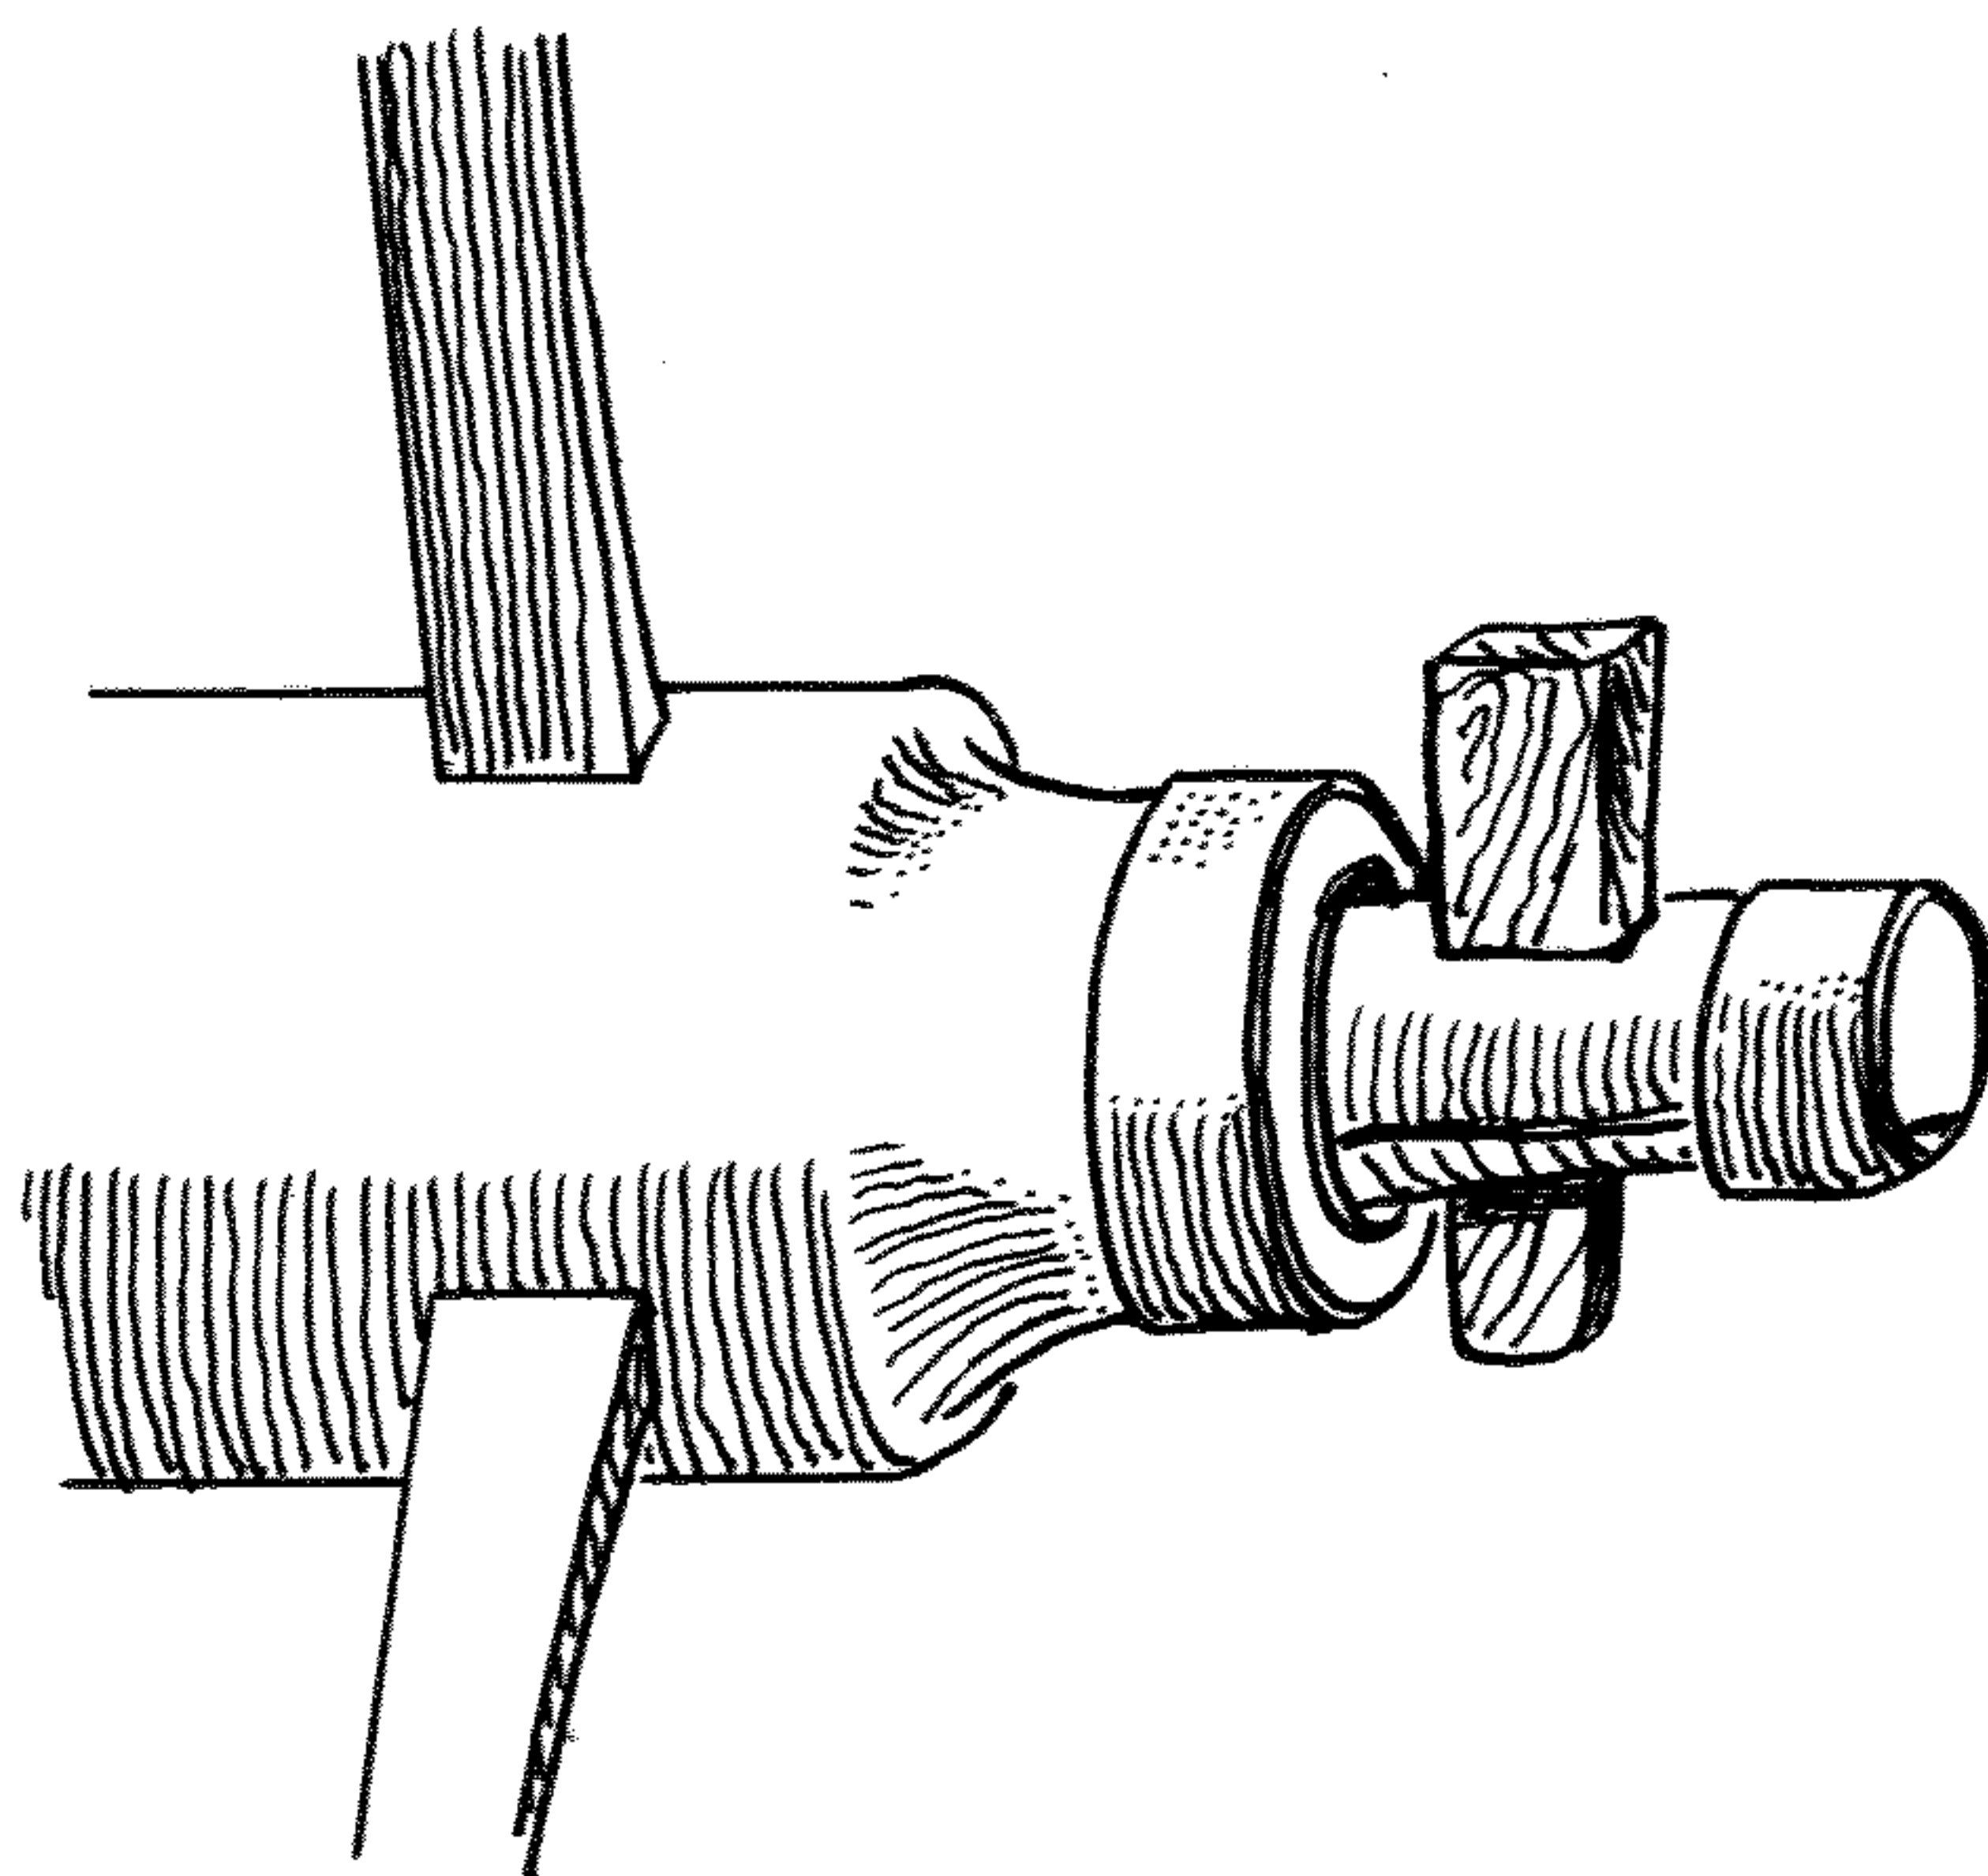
Zvětšená vložka do otvoru hlavy s výstupkem proti otáčení (průměr 6 - 12 cm)
